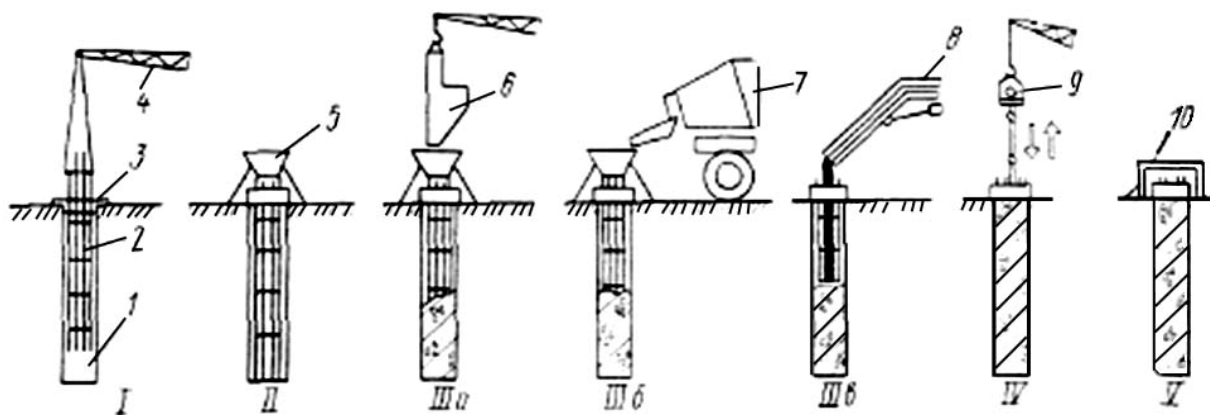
Технологическая схема бетонирования набивных свай: I – установка кондуктора и арматурного каркаса; II – установка опалубки и воронки; III а – бетонирование краном и бадьей; III б – бетонирование с использованием автобетоносмесителя; III в – бетонирование бетононасосами; IV – виброуплотнение бетонной смеси; V – утепление головы сваи; 1 – скважина; 2 – арматурный каркас; 3 – кондуктор; 4 – кран; 5 – воронка; 6 – бадья; 7 – автобетоносмеситель; 8 – распределительная стрела бетононасоса; 9 – виброуплотнитель; 10 – утеплитель
